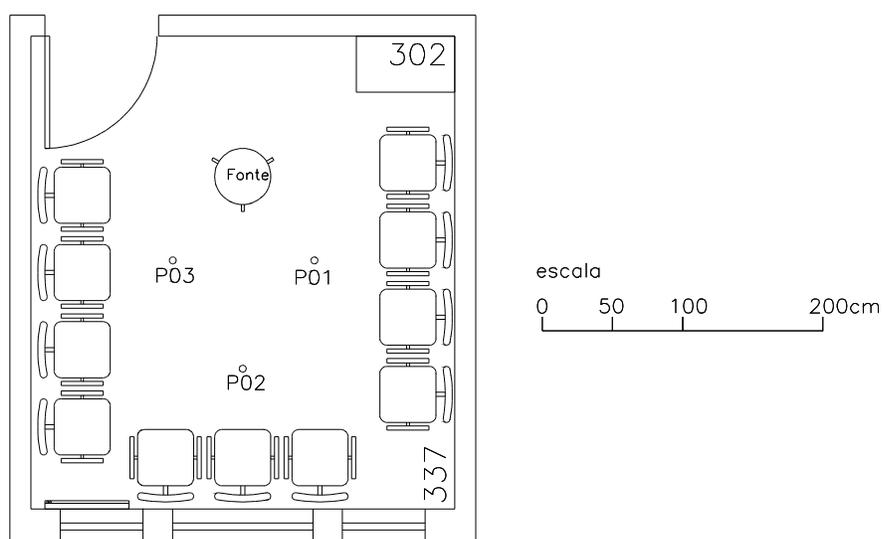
Planta da sala de aula da escola E07 localizada na Rua João Batista Antonielli.
